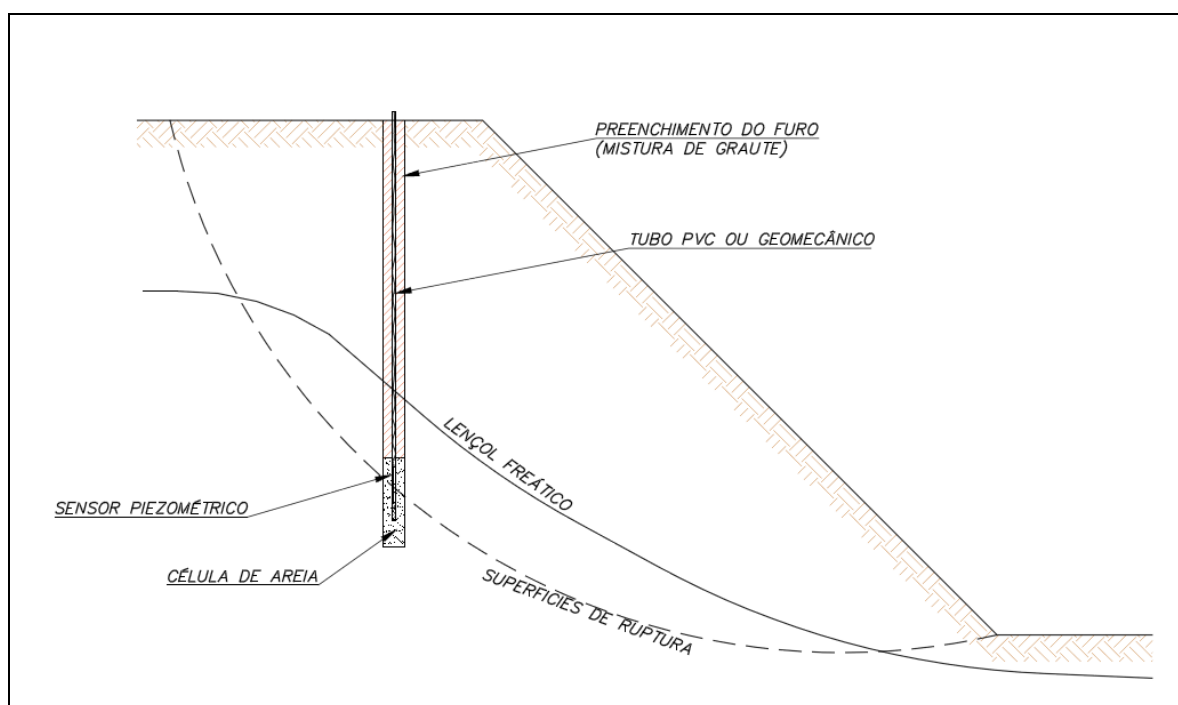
Perfil construtivo típico de um Piezômetro Casagrande instalado em taludes de infraestrutura ou encostas naturais (Fonte: O autor, 2016).
